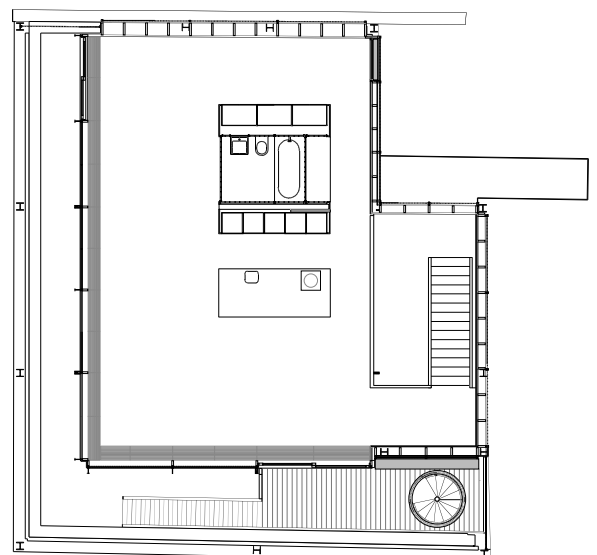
Grundriss 4.OG © Tonkin Liu
